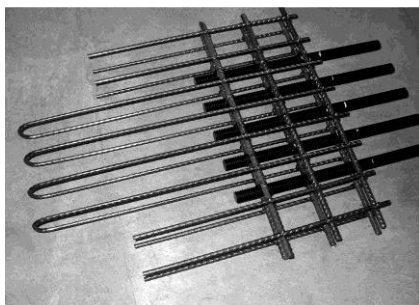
Schlaufenförmige Stabstahlbewehrung
